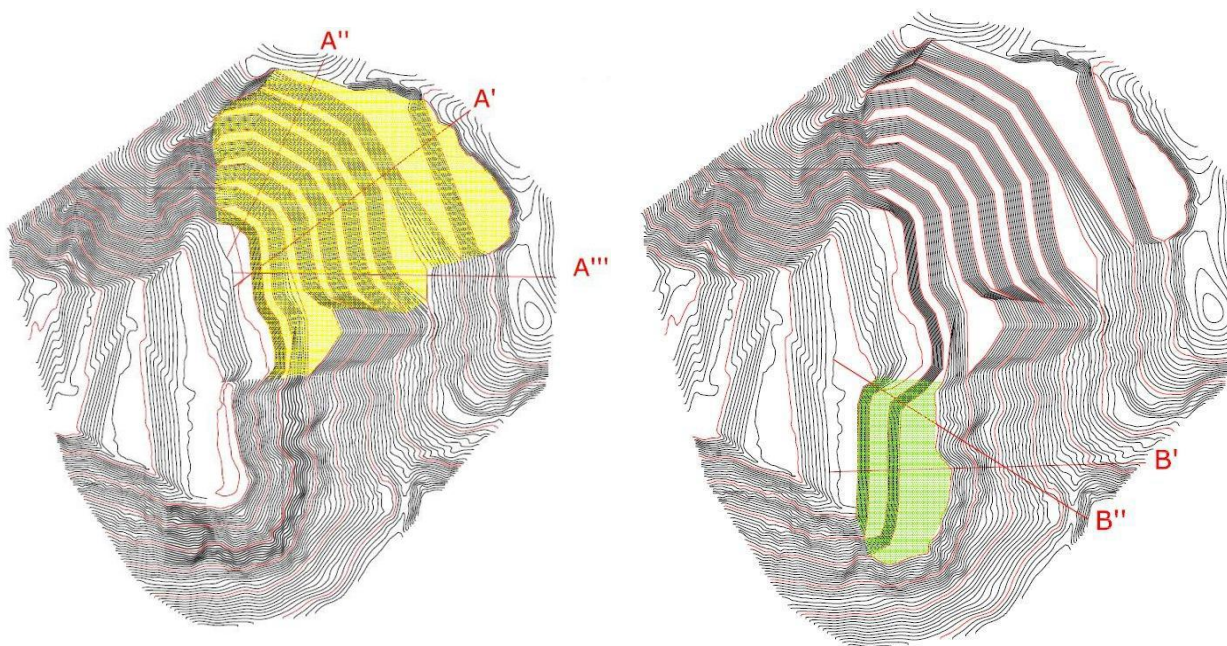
(sopra e seguente): Planimetrie di progetto con indicazione degli Stralci Funzionali
